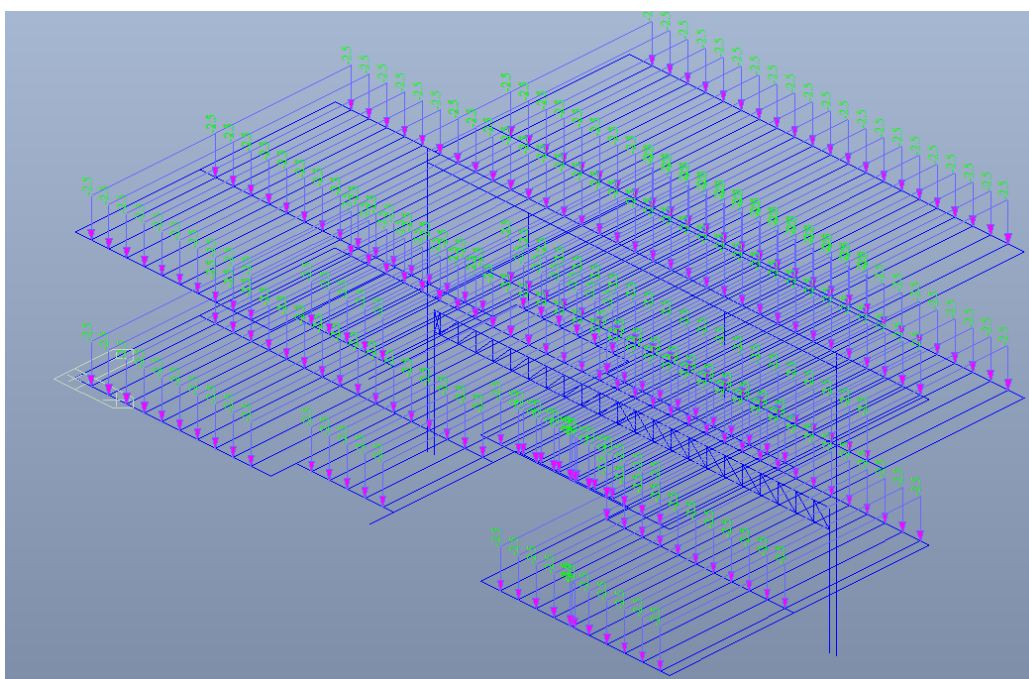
Applicazione dei carichi sul solaio ai travetti (caso del p.p. solaio)
